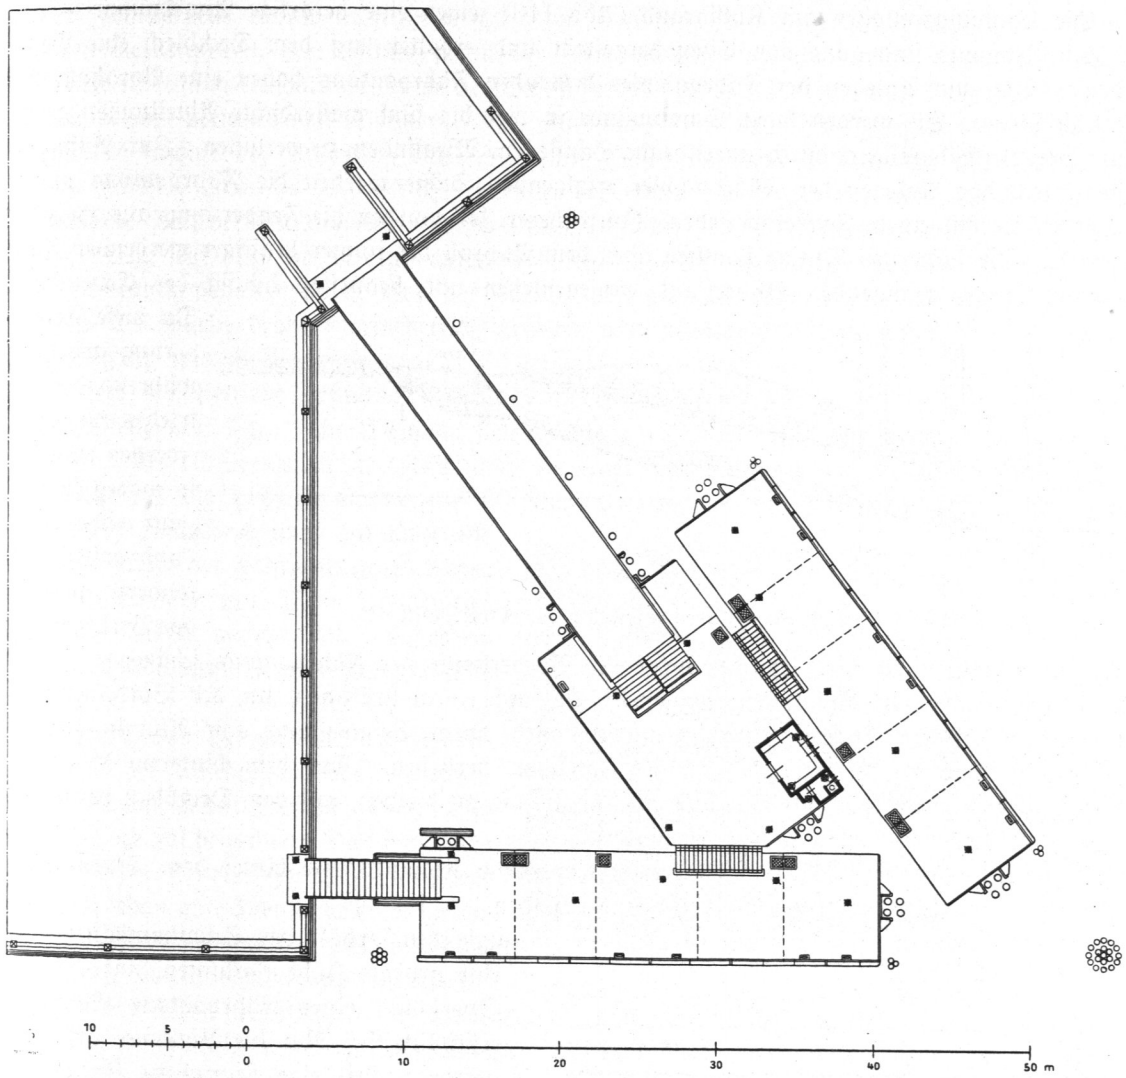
Landungsanlage am Kofshöft, Lageplan.
